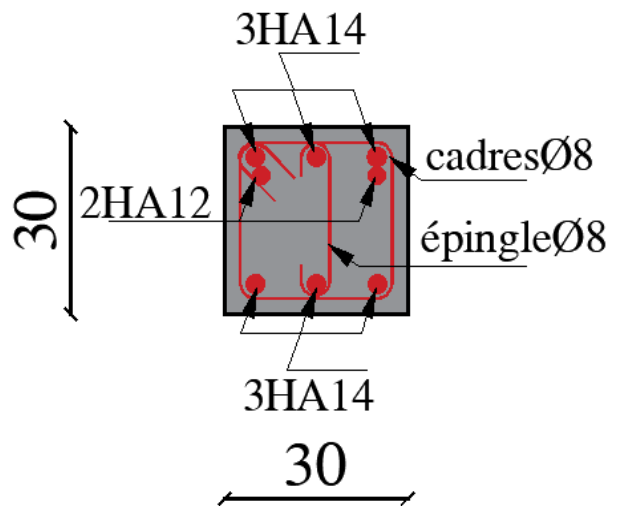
Schéma de ferrailage de la poutre secondaire renforcée
